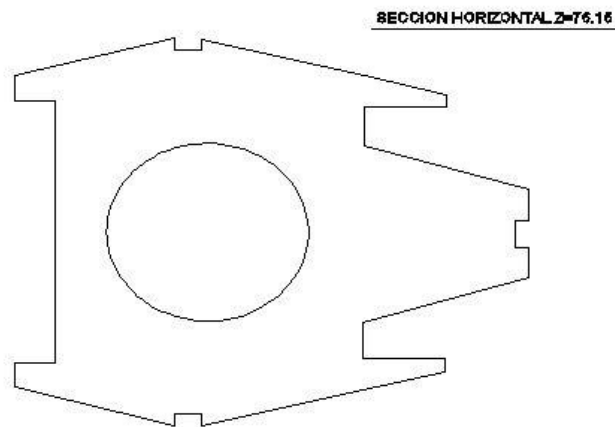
Sección horizontal pilono cota Z=76.15 m.
